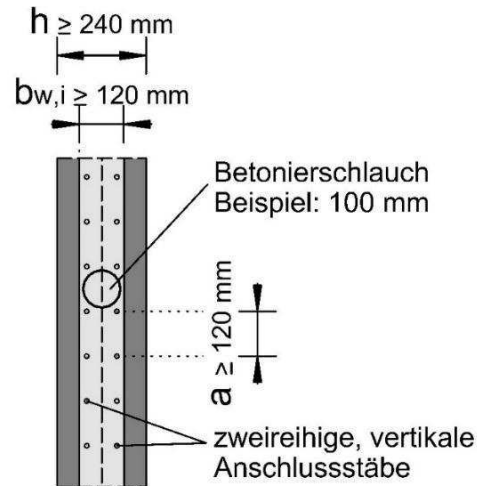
Mögliches Einbringen eines Betonierrohres in eine Elementwand mit Wanddicke von 240 mm bei zweireihiger Anschlussbewehrung aus einzelnen vertikalen Bewehrungsstäben mit Mindestabstand in Wandlängsrichtung
